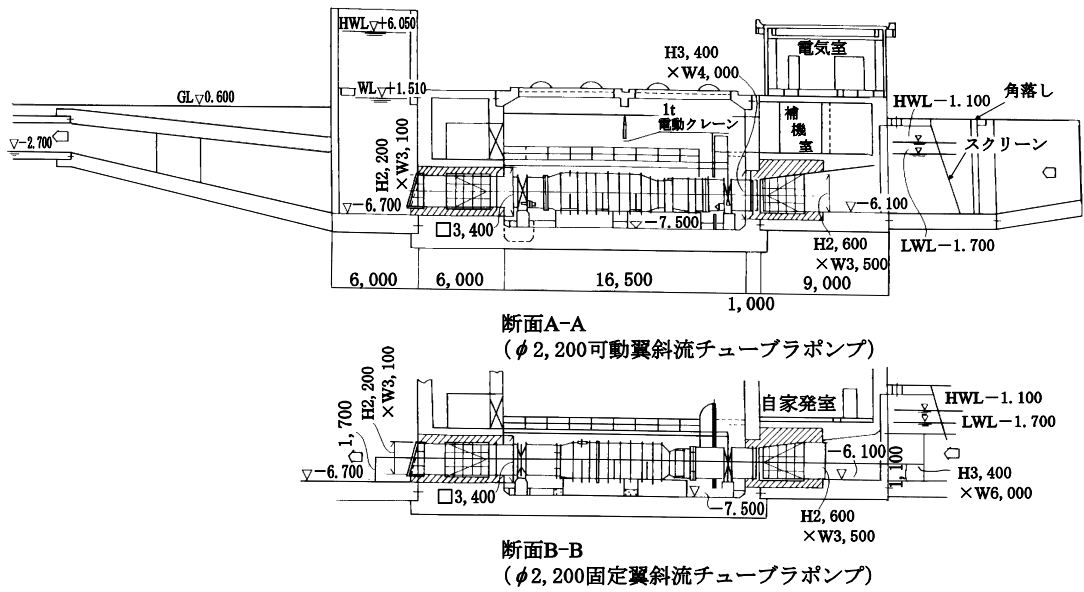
(a)-参 横軸可動羽根斜流チューブラポンプ、横軸斜流チューブラポンプ平面図 (例)
